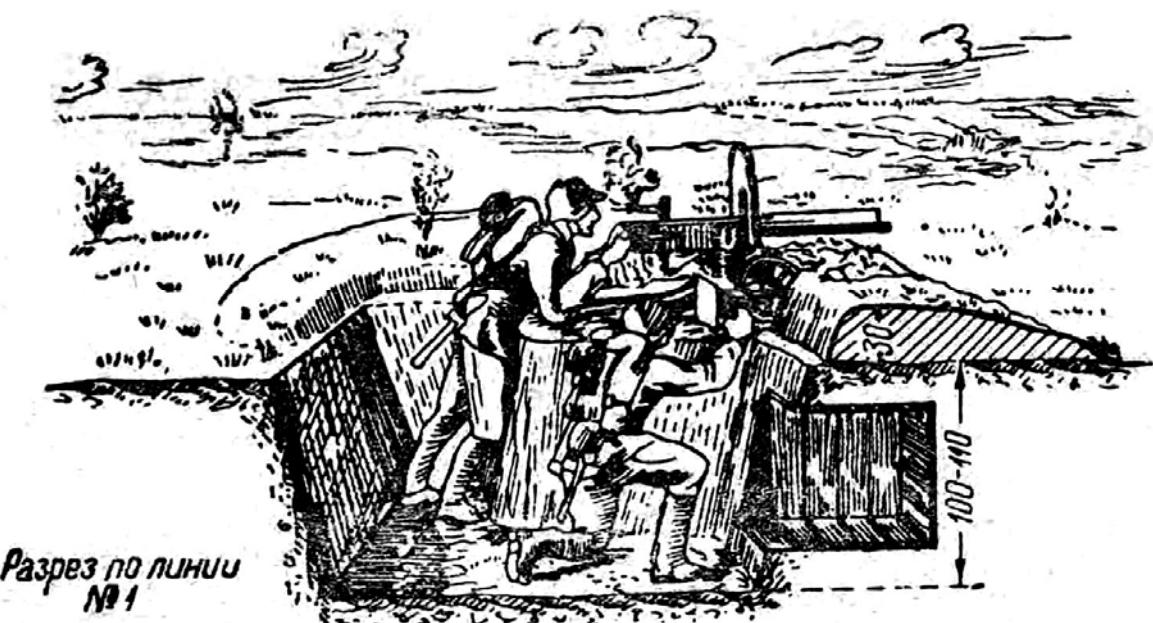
Ячейка для стрельбы стоя из станкового пулемета.
